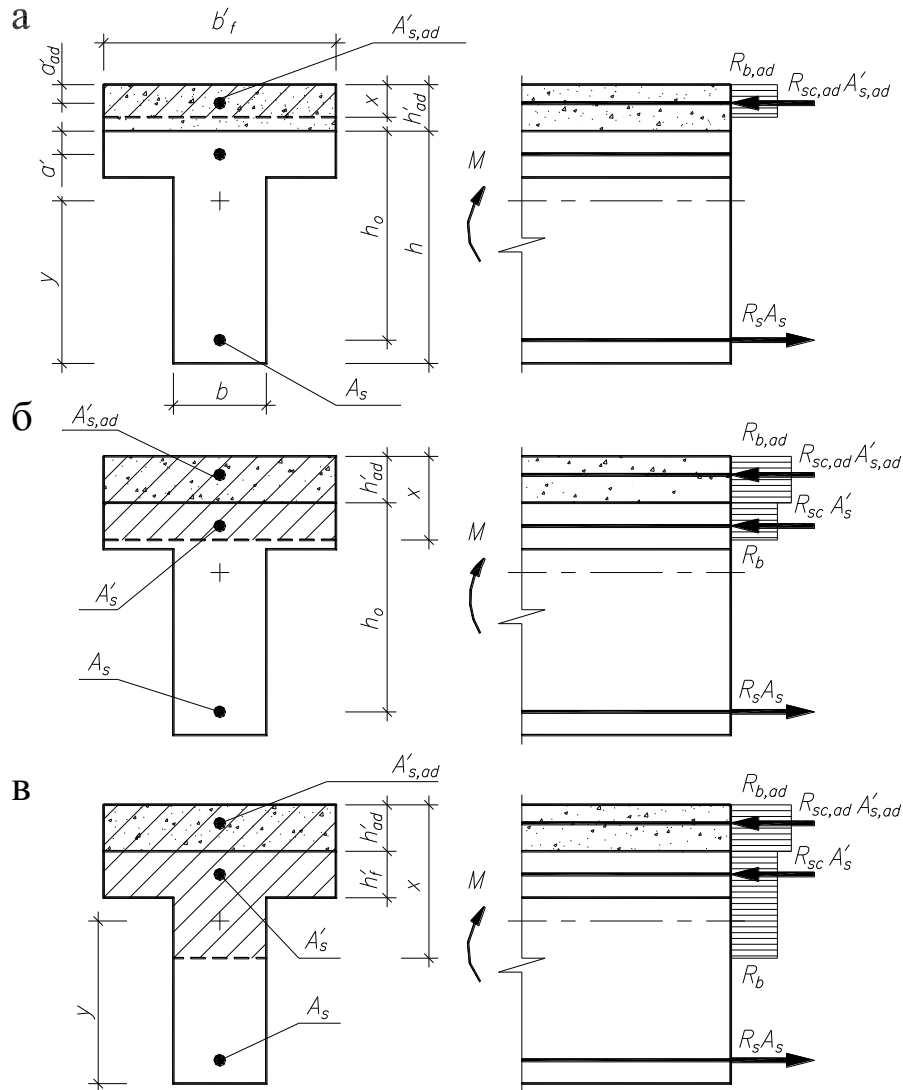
Схемы усилий и эпюры напряжений в тавровом сечении с полкой в сжатой зоне элемента, усиленного наращиванием, при $\xi \leq \xi_R$:
